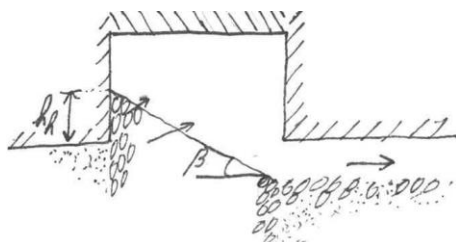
Uitspoeling van bovendeele barrière aansluitend op benedenstroomse pipe tot ongeveer een hellingshoek gelijk aan de hoek van inwendige wrijving. De geschetste situatie betreft een relatief brede barrière met een relatief lage inkassing (zijaanzicht met enige 3D-suggestie in langsrichting).
